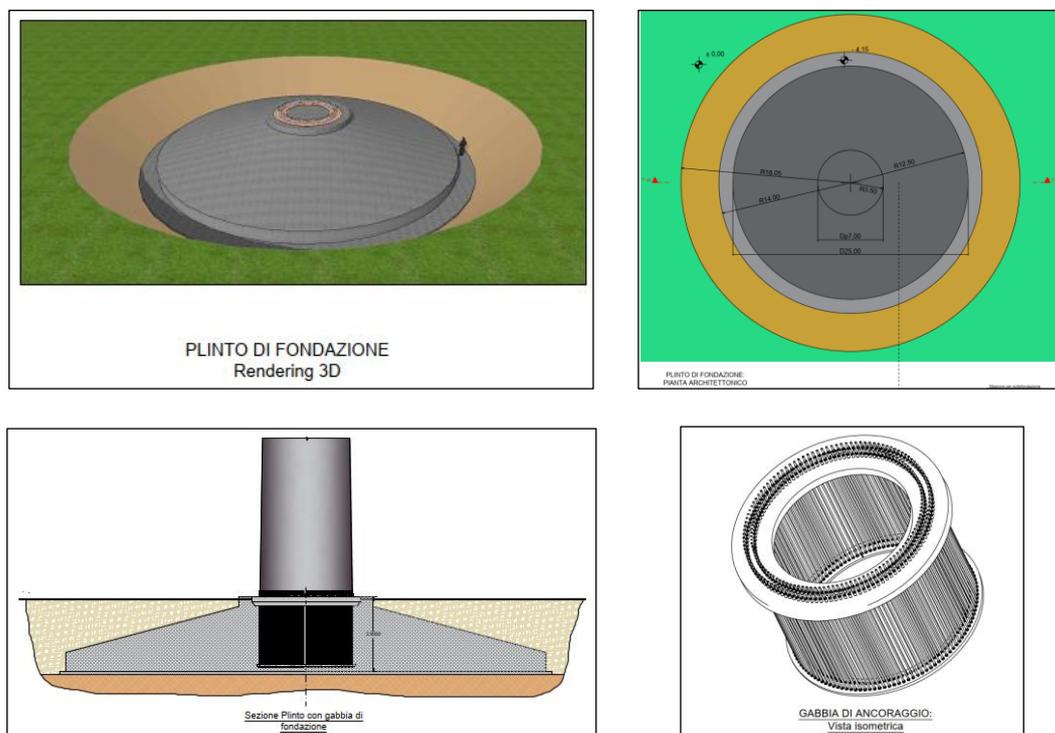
Stralcio Elaborato di Progetto “NIR.ELB05b” Schema Plinto Aerogeneratore - Sezione
